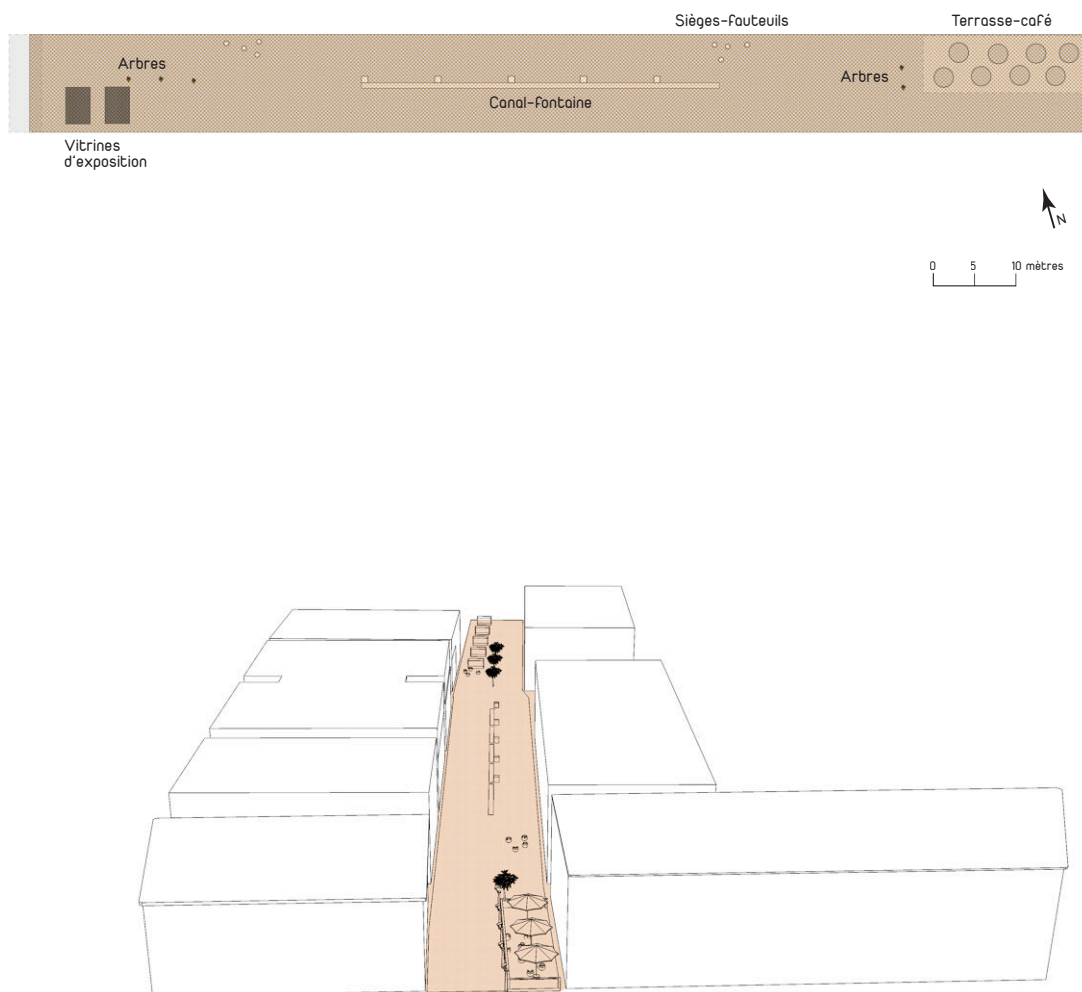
Plan de site et vue 3D de la Promenade urbaine (Source : lan Losa)
